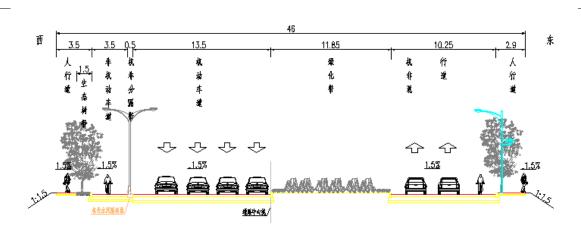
康园路(桩号 0+560-0+660) 横断面示意图
